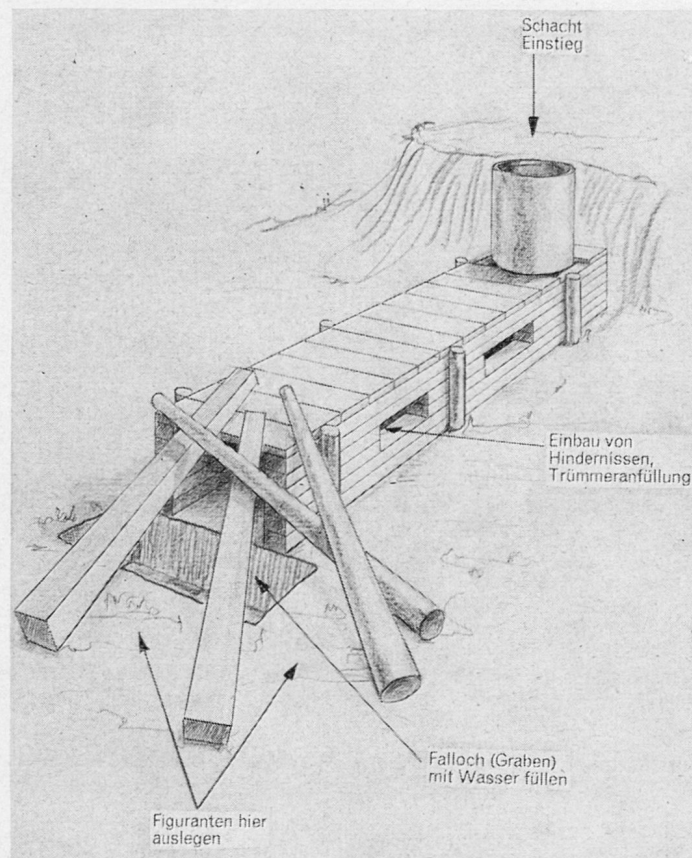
Schacht mit Schlupfweg und Falloch. Konstruktionsskizze.
